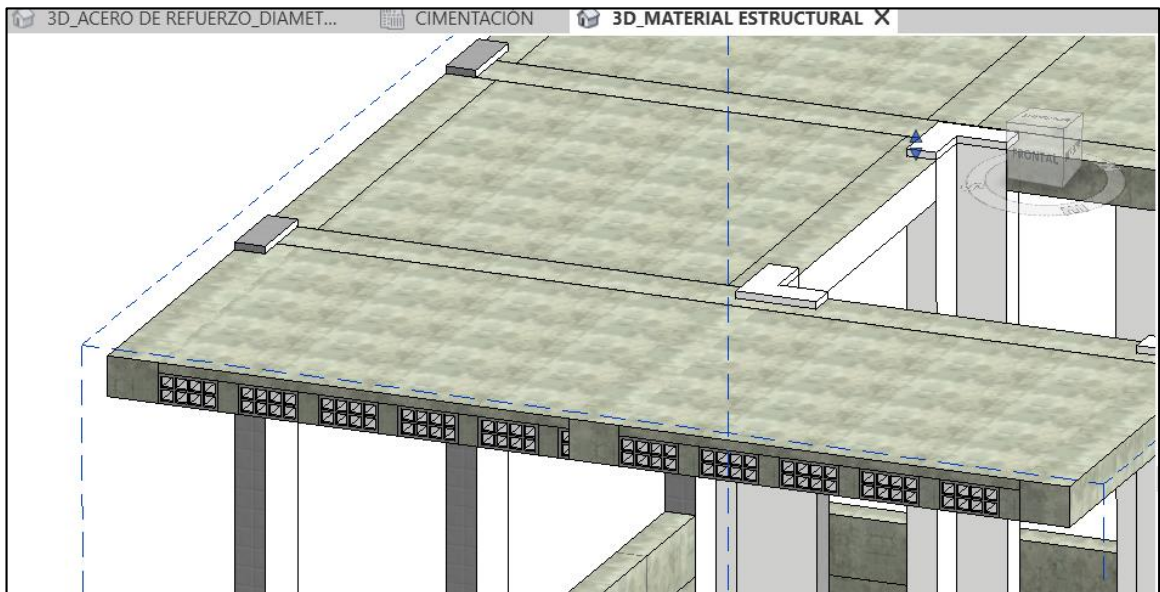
Vista 3D - Losa aligerada en Caja de sección en BIM
